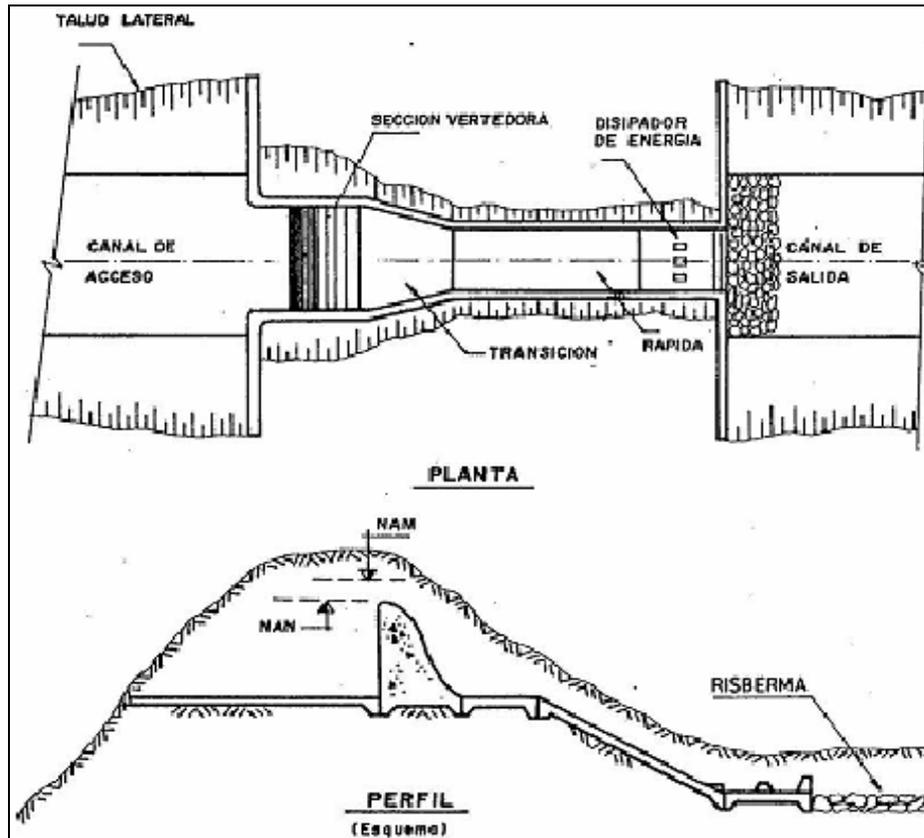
Esquema de un aliviadero en vista en planta (arriba), vista de perfil (abajo). Fuente: (Diseño Hidráulico de aliviaderos y obras de toma para presas, 2012)
